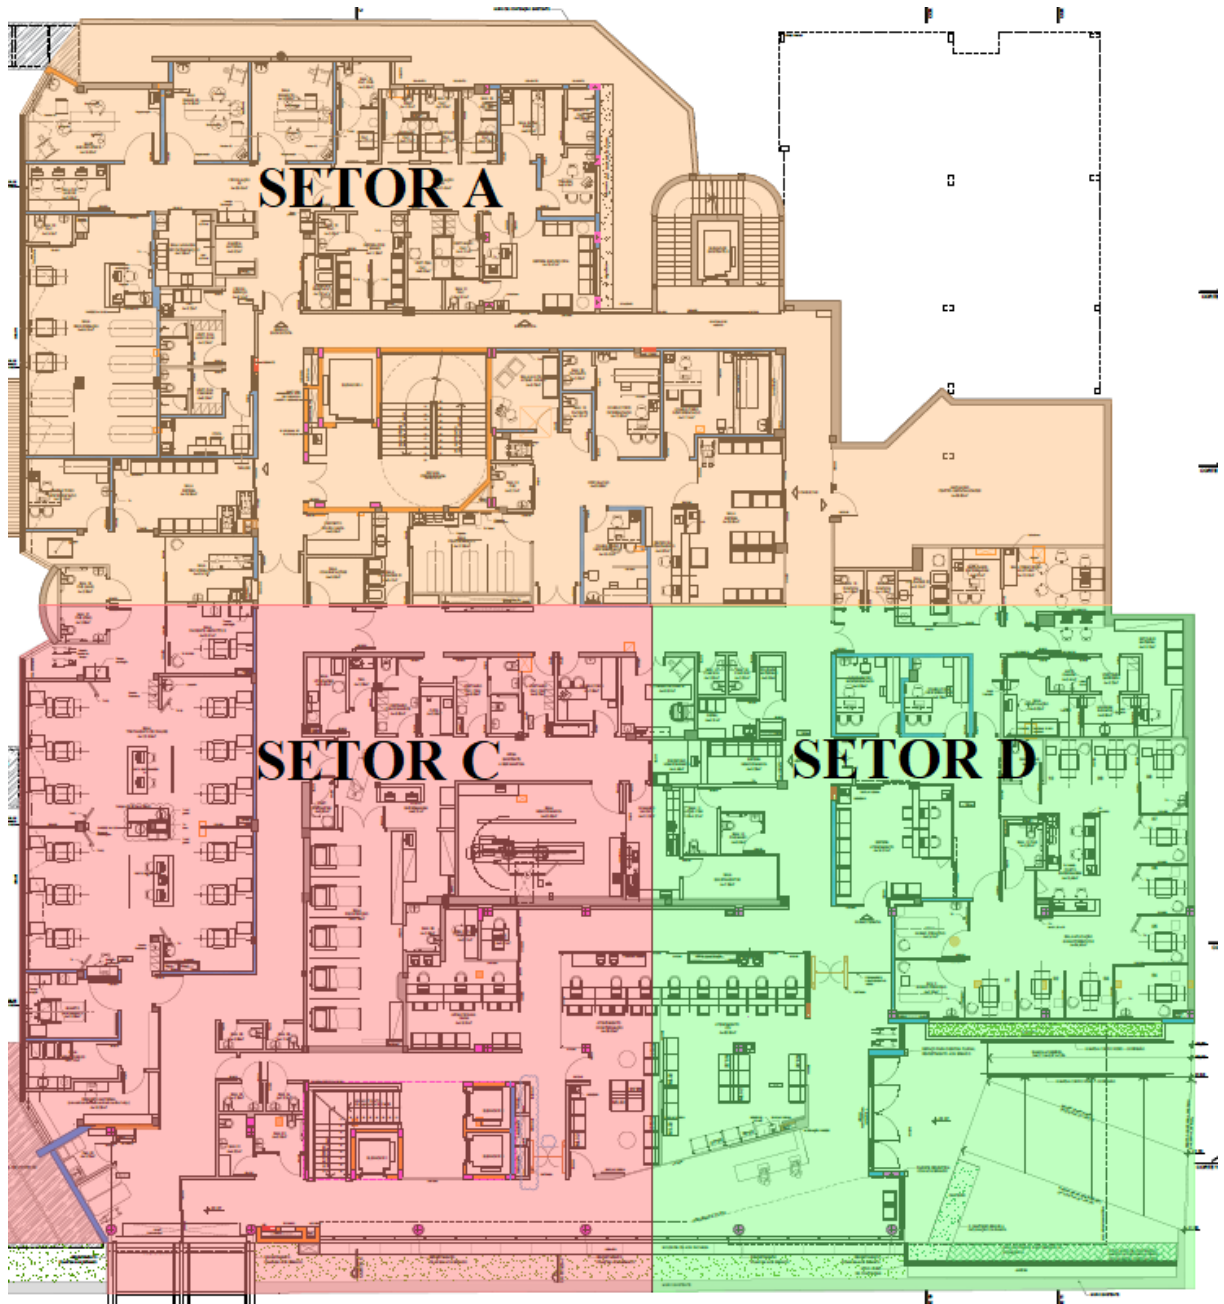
Zonas de trabalho existentes na obra – Segundo Pavimento
